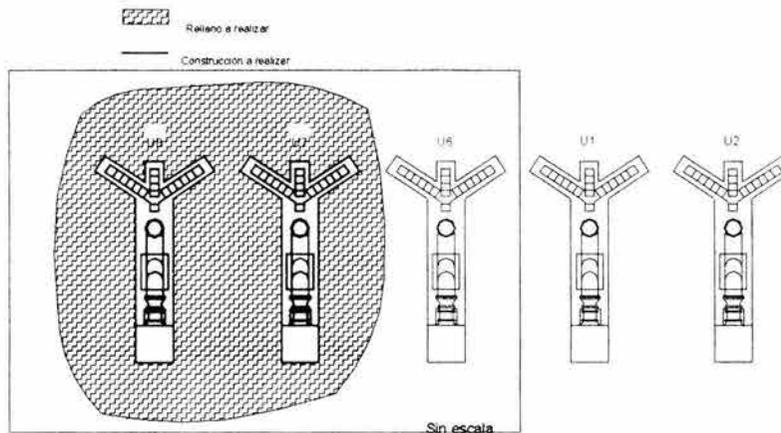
Vista en planta de la plataforma de lumbreras por construir en la 2ª Etapa.
